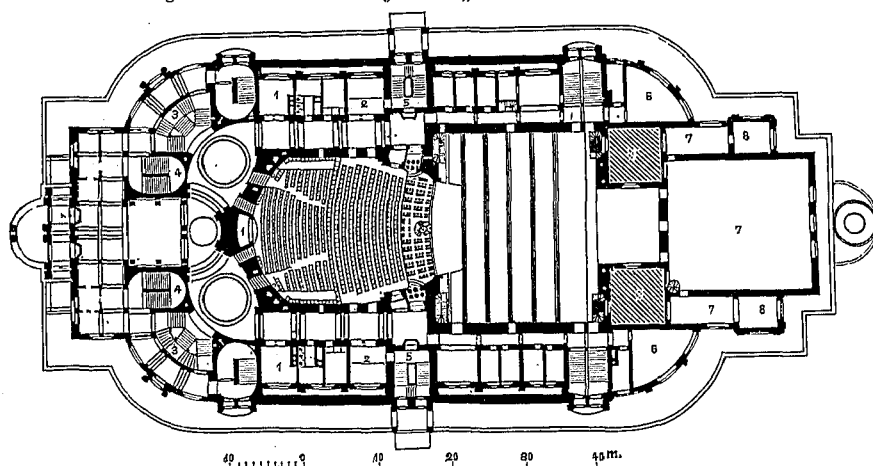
Grundriss zum Proj. Motto „Doch die Elemente lassen etc.“
